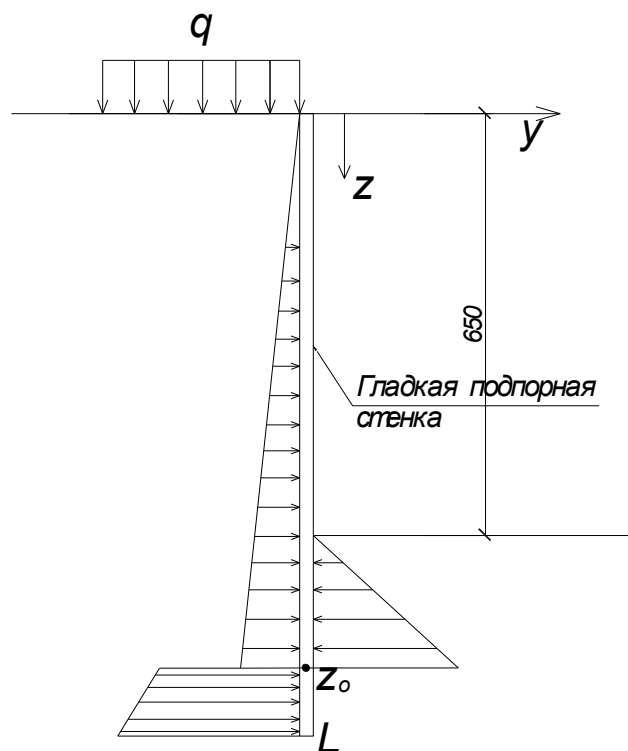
Эпюры давлений грунта на шпунтовую стенку
